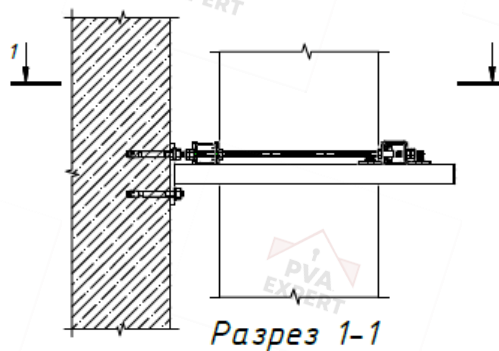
Узел крепления прямоугольного воздуховода к стене обхва-
